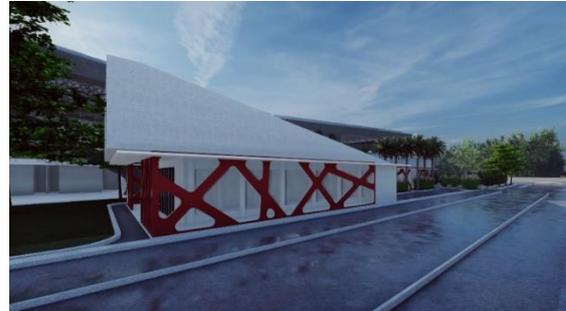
Penggunaan Material kaca, baja dan dindin beton
